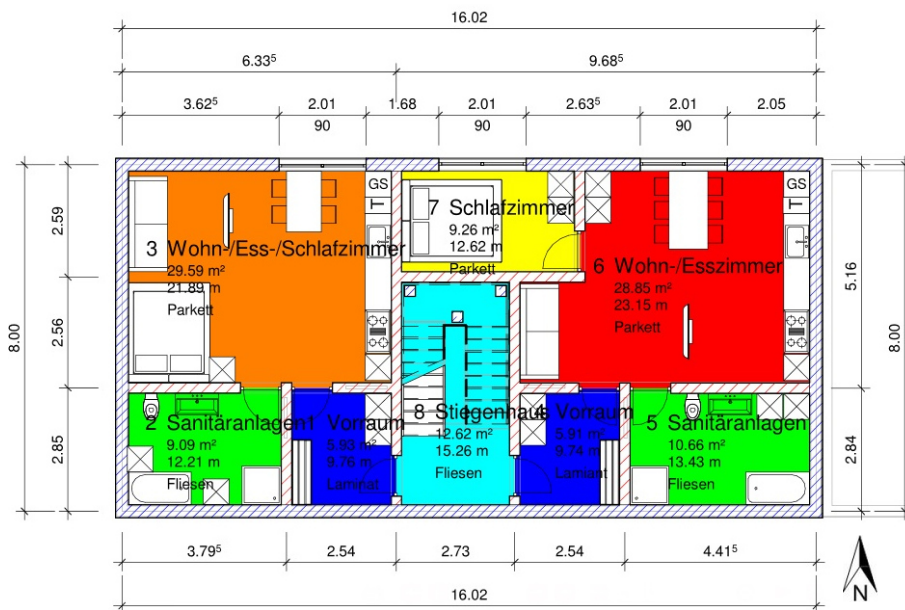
KG Ausbau - Grundriss KG
